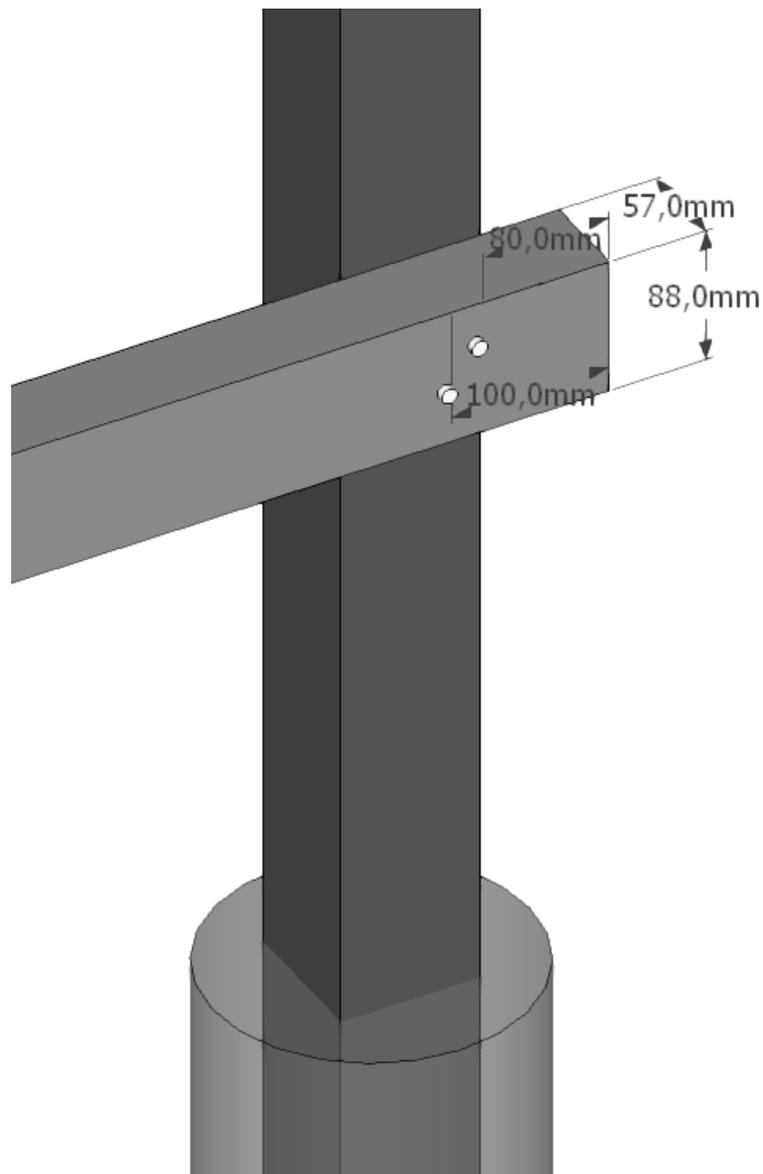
Imagem ilustrativa do parafusamento das vigas do piso nos pilares.
